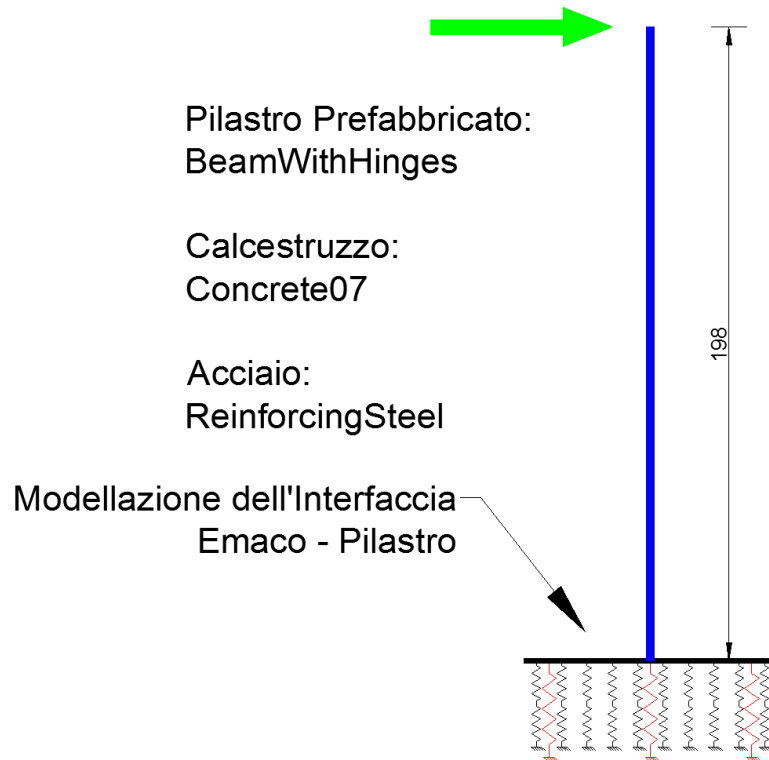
Modellazione alternativa sistema Pilastro – Emaco
